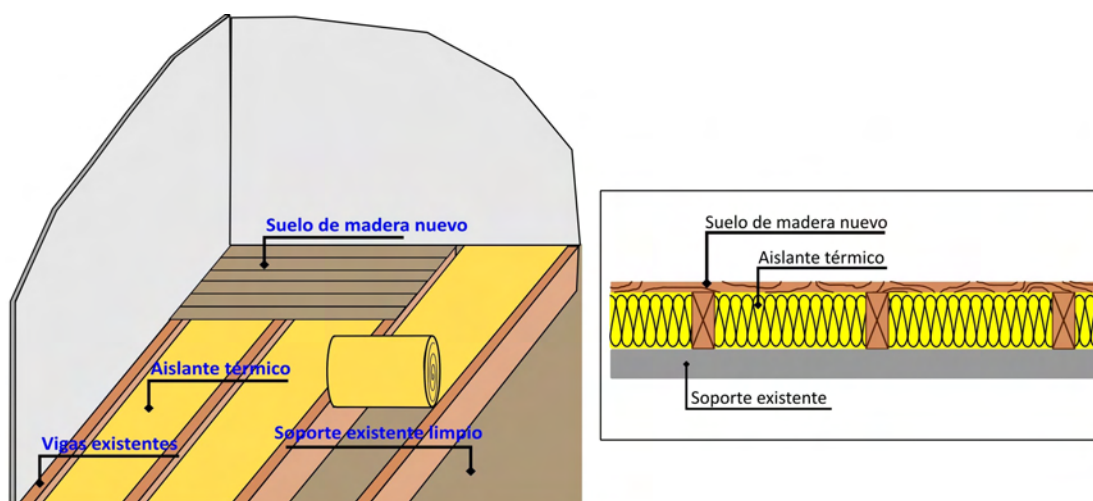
Forjado de madera. Instalación del aislamiento por la cara superior
